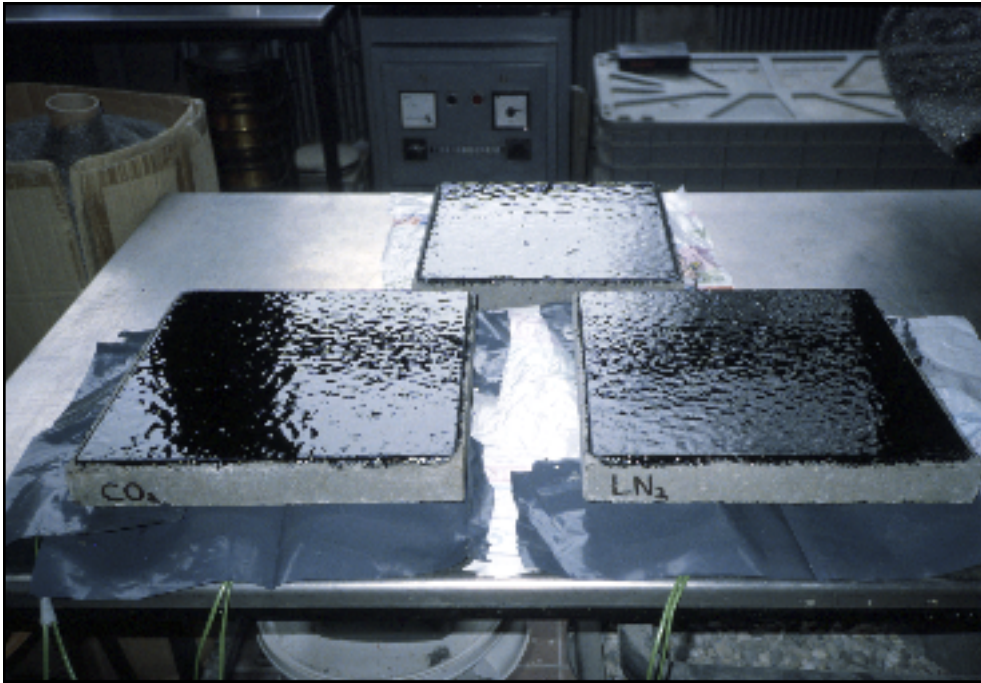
Bitumenschutzanstrich Eurolan 1
